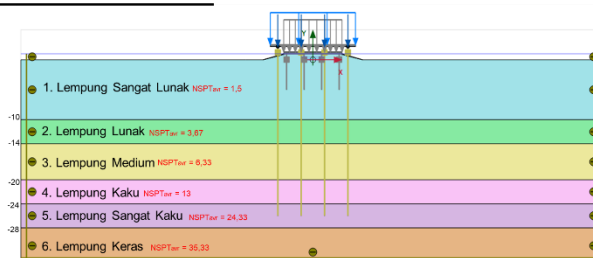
Tipikal Penanganan Alternatif 1: Pile Slab
